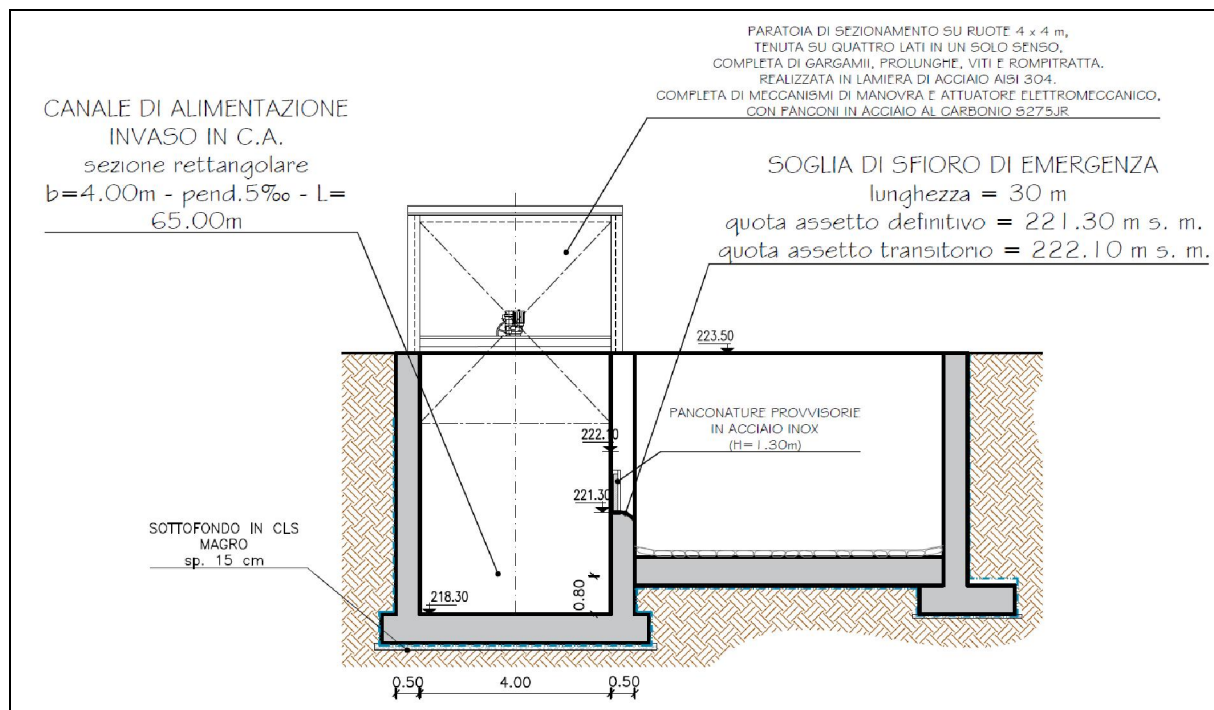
Sezione trasversale del canale di alimentazione, nel tratto a monte dell'attraversamento della linea ferroviaria, con indicazione della paratoia di sezionamento
